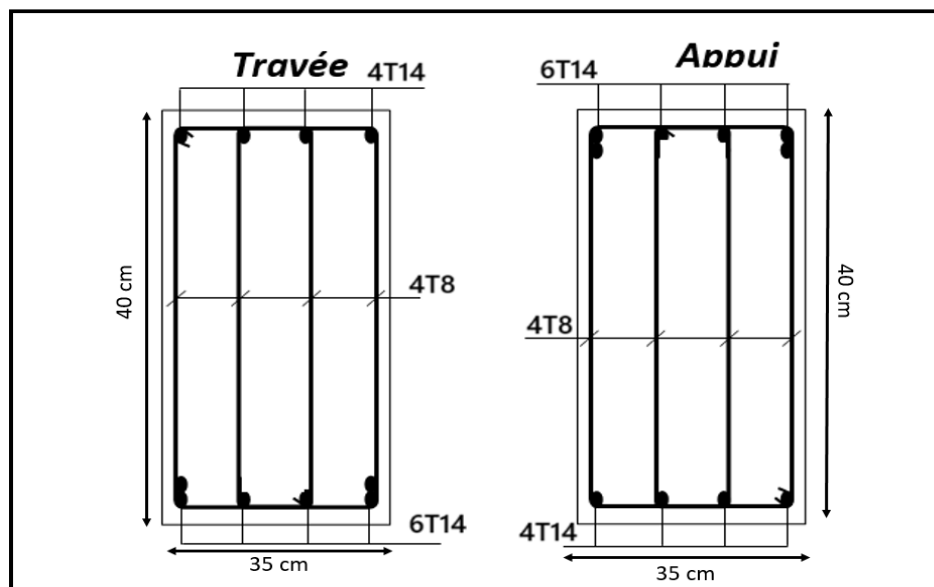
Schéma de Ferrailage des Poutres principale.
